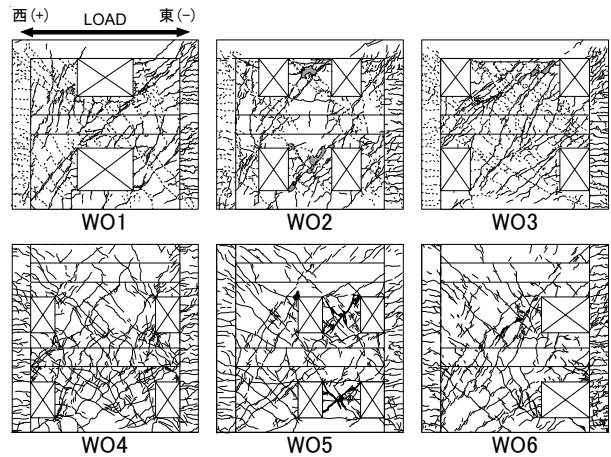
ひび割れ損傷状態 ($R=1/133rad.$)
